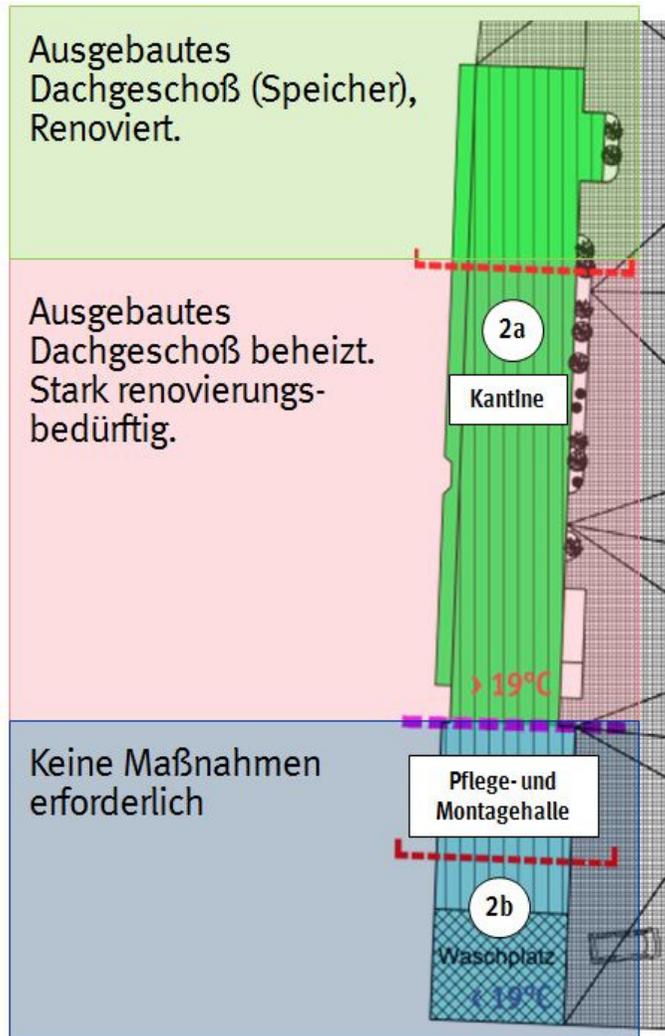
Konzeptplan Gebäude 2 – Kantineengebäude / Pflege- und Montagehalle
